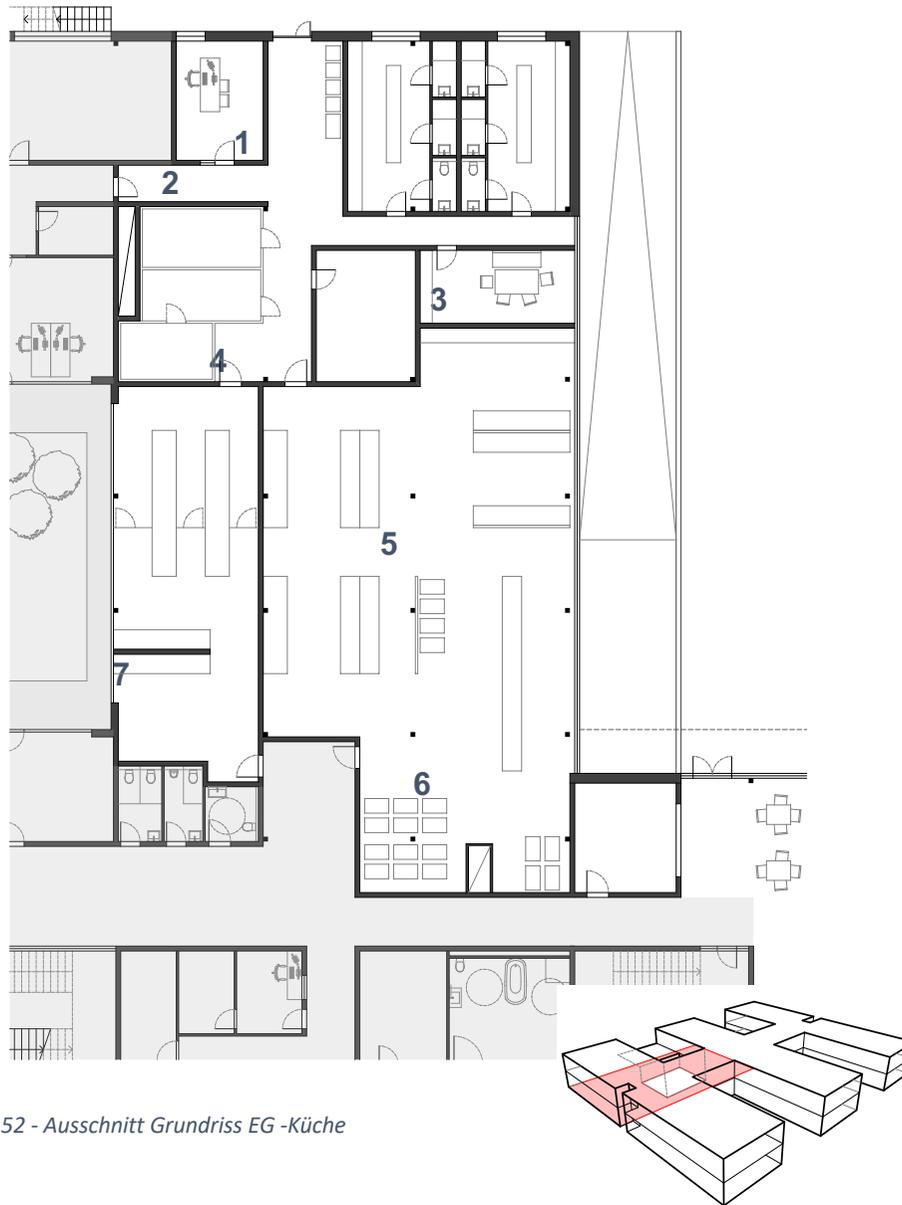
Ausschnitt Grundriss EG - Küche
